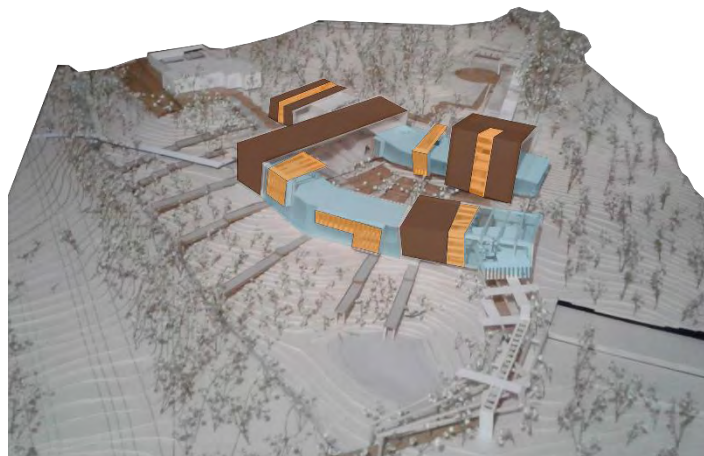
Fotografía maqueta fachadas. Fuente: Elaboración propia
